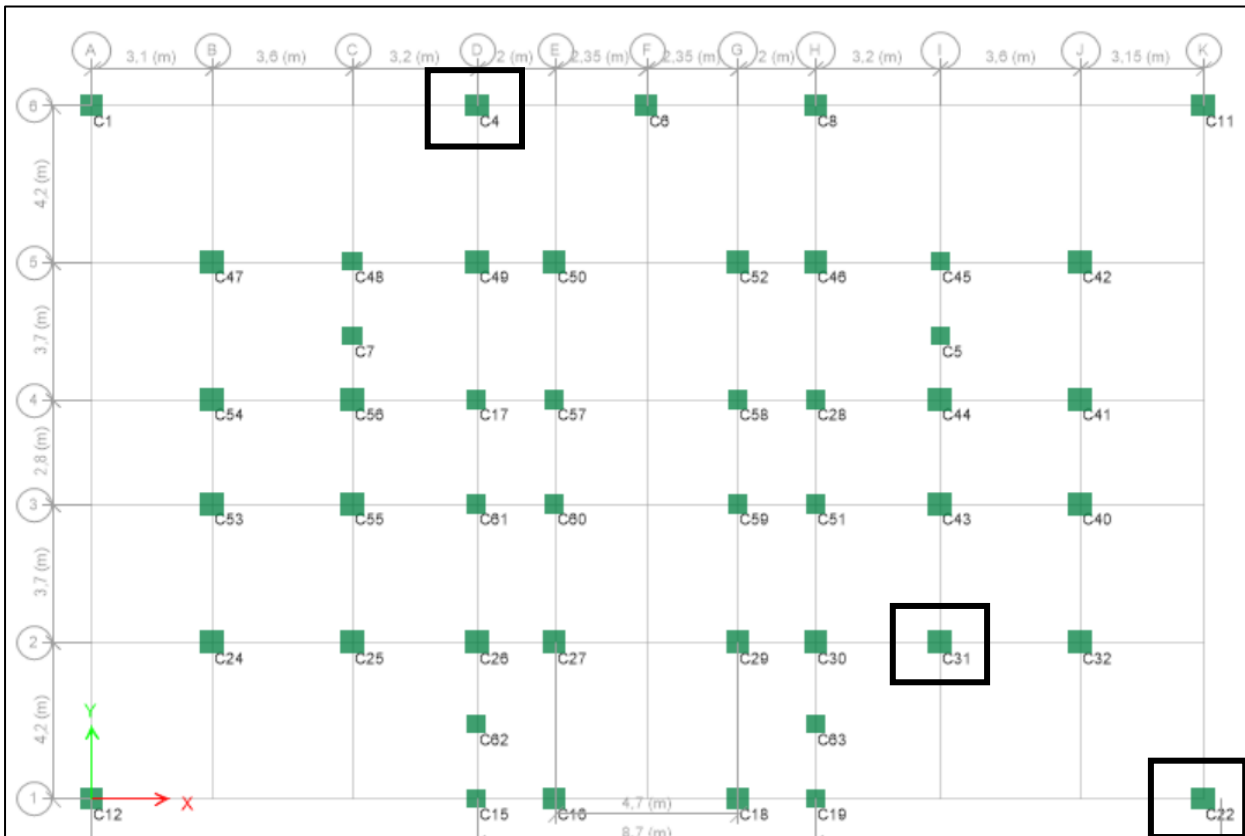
Exemples de poteaux (Centrale C31, angle C22, de rive C04)
